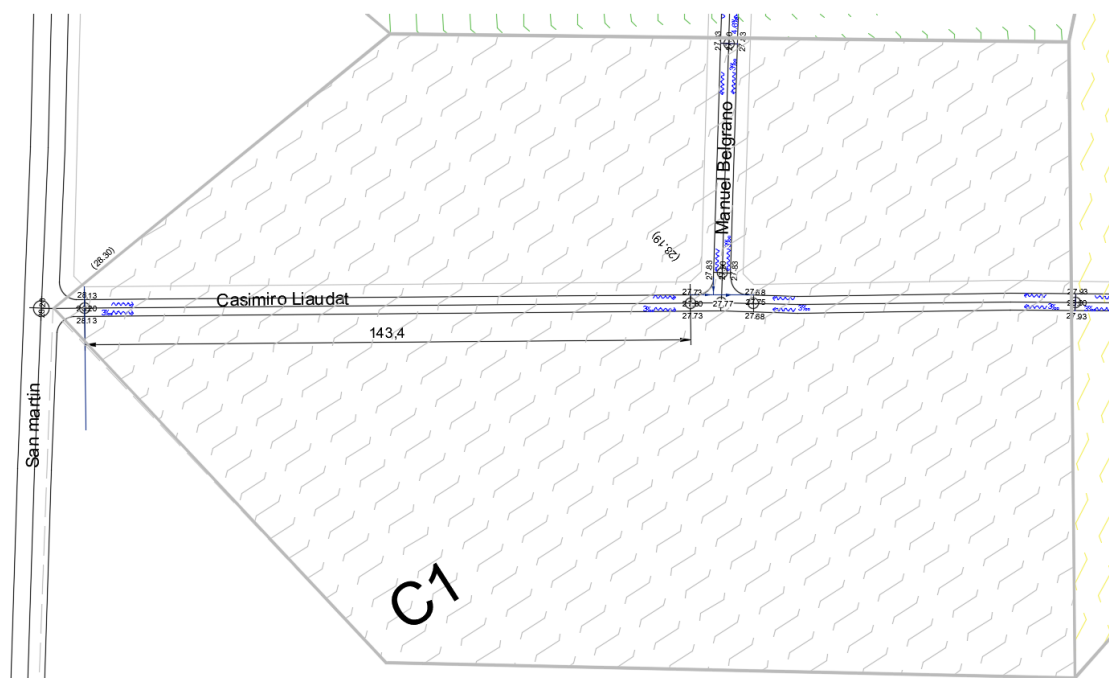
Cuenca 1 Barrio Sur. Fuente: Plano general de subcuencas
